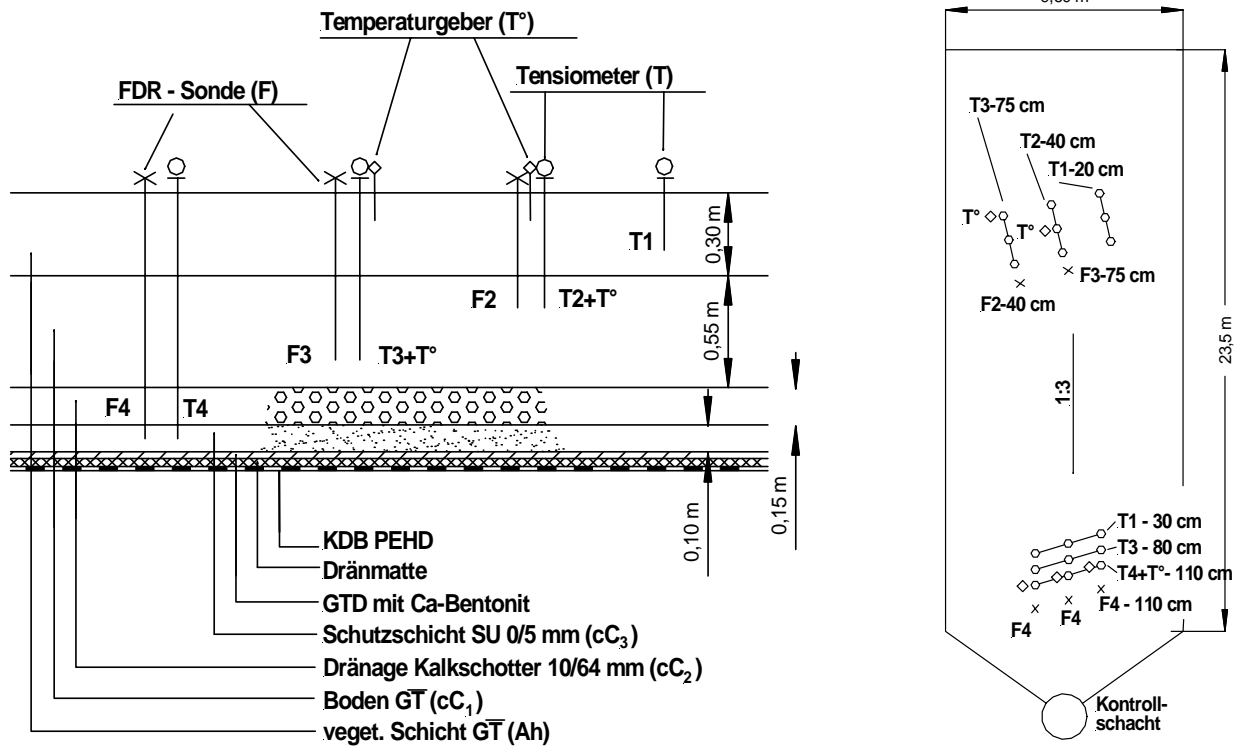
Lysimetermessfeld: Lageplan und Systemschnitt mit messtechnischer Instrumentierung
